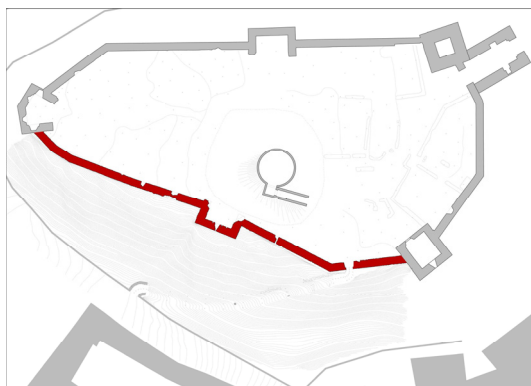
Planimetria\_ La porzione di castello oggetto di intervento
